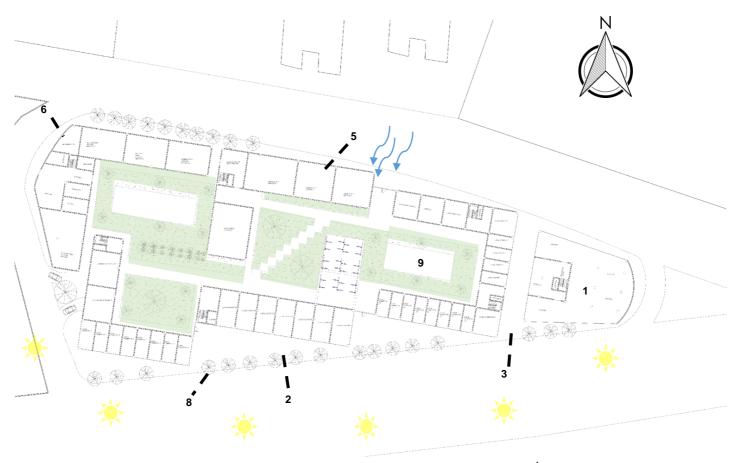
Quinta propuesta. Planta. Elaboración conjunta, Álvarez, González, Hurtado. 2022
